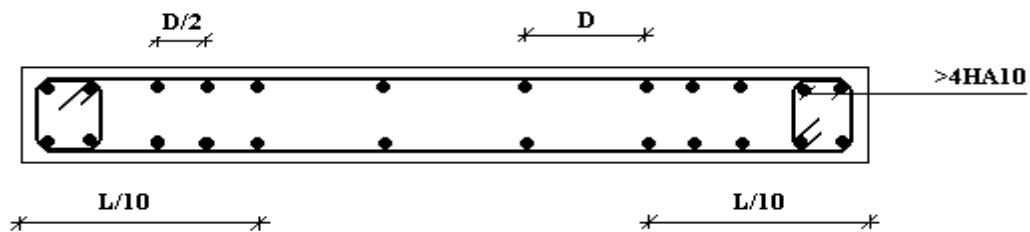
Disposition des Armatures verticales dans les voiles
